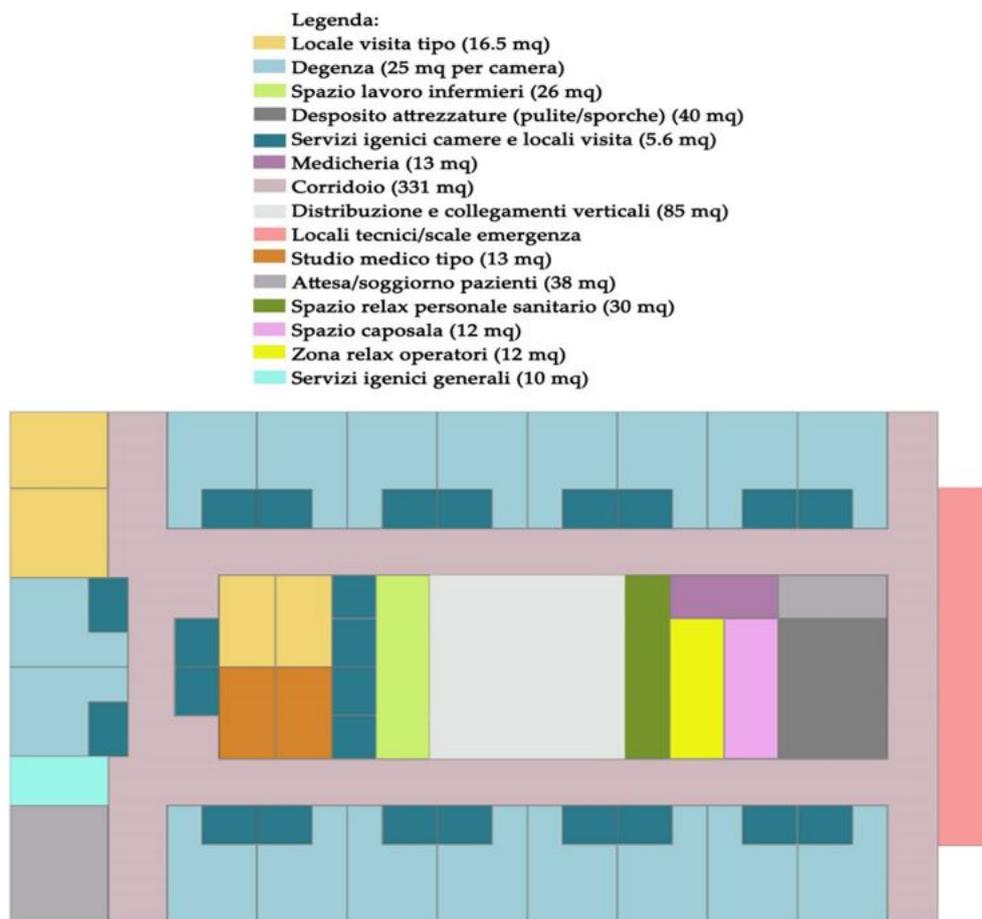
Legenda e planimetria schematica del piano degenza tipo dell'ospedale.
